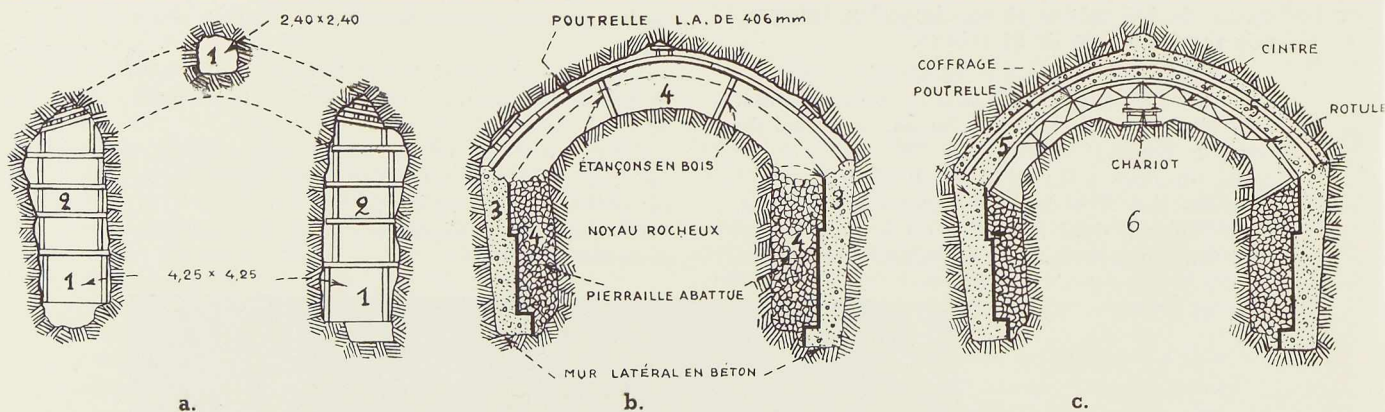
a-b-c. Figures montrant la suite des opérations de la construction du tunnel de Yerba Buena. On notera le rôle des poutrelles à larges ailes qui assurent le soutènement des terres, avant le bétonnage, et constituent l'armature de la voûte.
